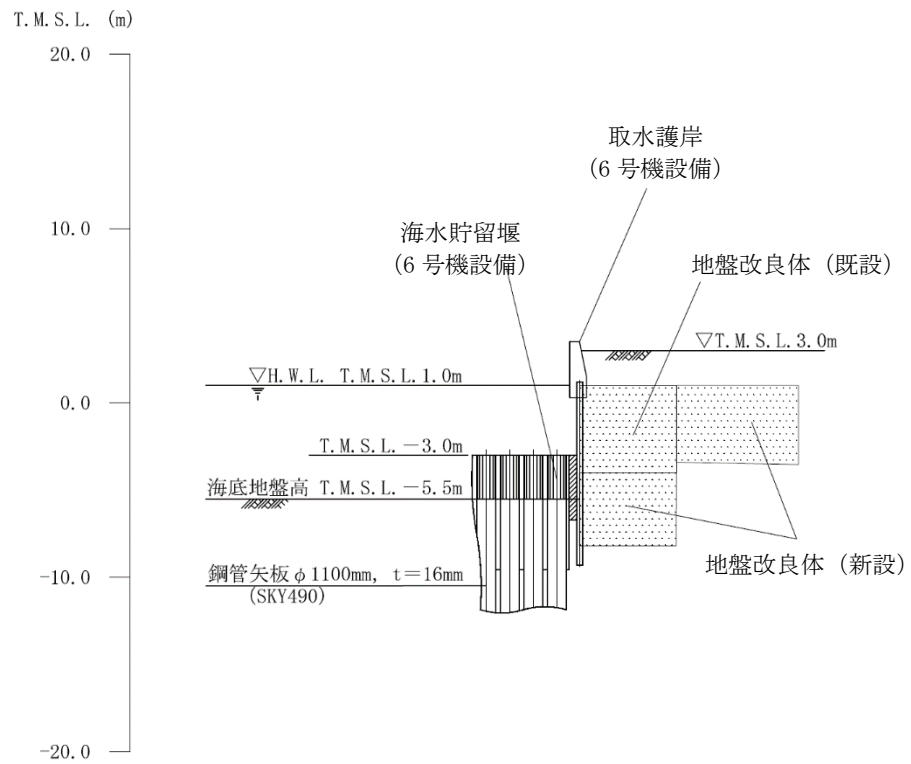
取水護岸 (6号機設備) の標準断面図 (A-A断面)
